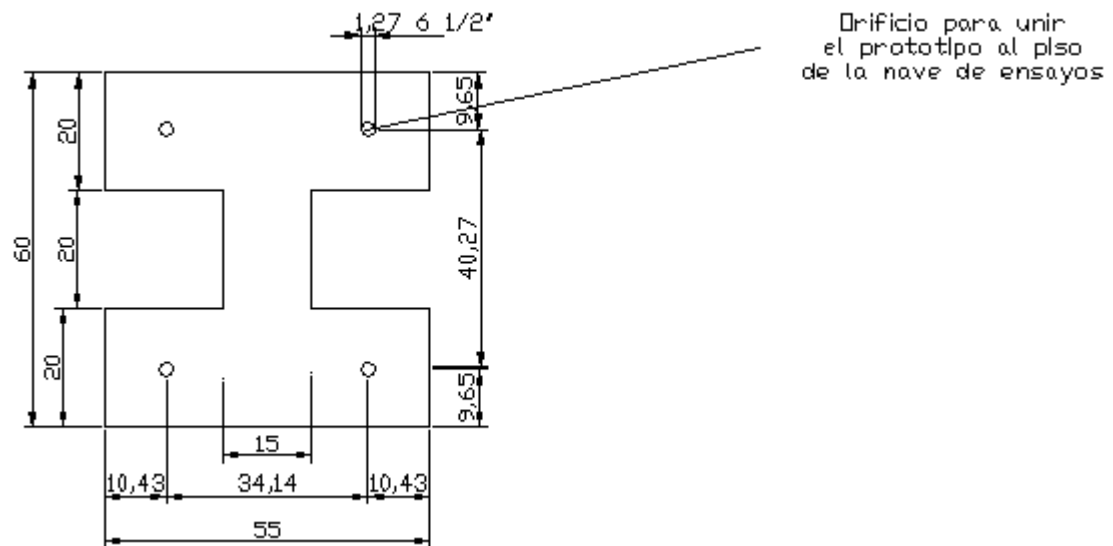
Especimen tipo para ensayo de carga alternante, dimensiones en mm.
